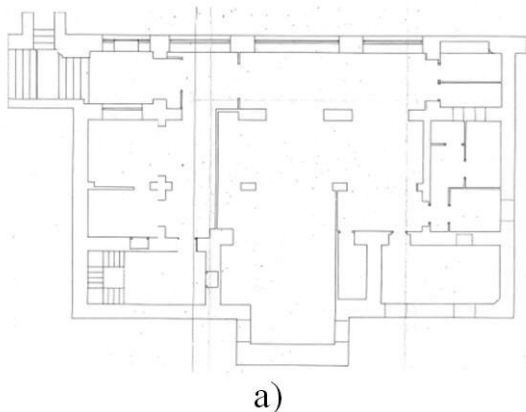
Planos de proyectos precedentes; a) Planta de sótano. Proyecto de Restauración del Pabellón administrativo del Mercado Central y reutilización como Caja de Ahorros de Valencia, 1983; b) Planta primera. Proyecto de Restauración del Pabellón administrativo del Mercado Central y reutilización como Caja de Ahorros de Valencia, 1983
